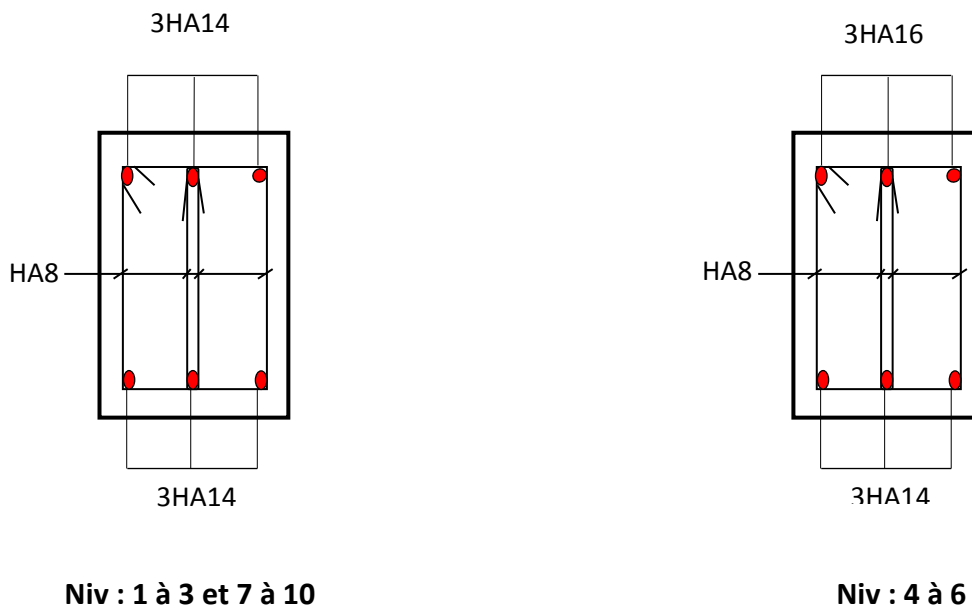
Coupes verticales des poutres secondaires non adhérees aux voiles au niveau des appuis
